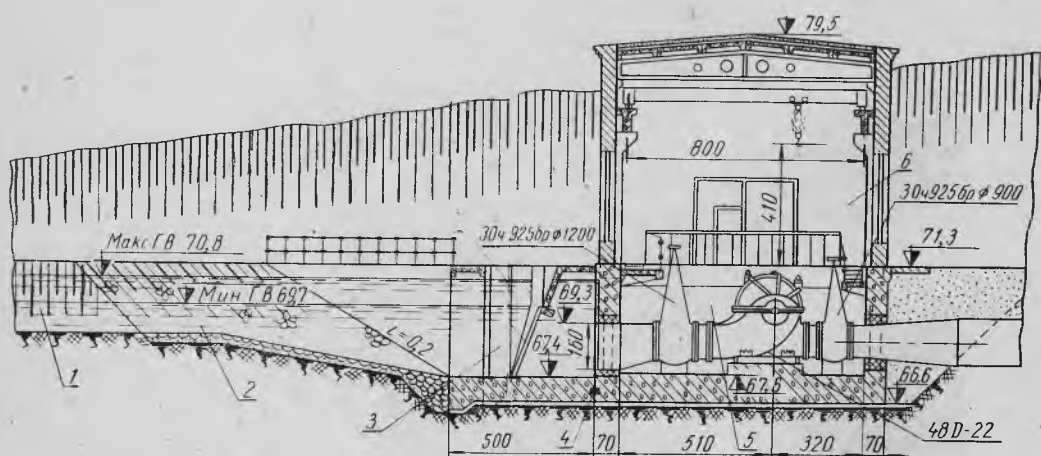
Поперечный разрез здания насосной станции камерного типа с сухой камерой:
